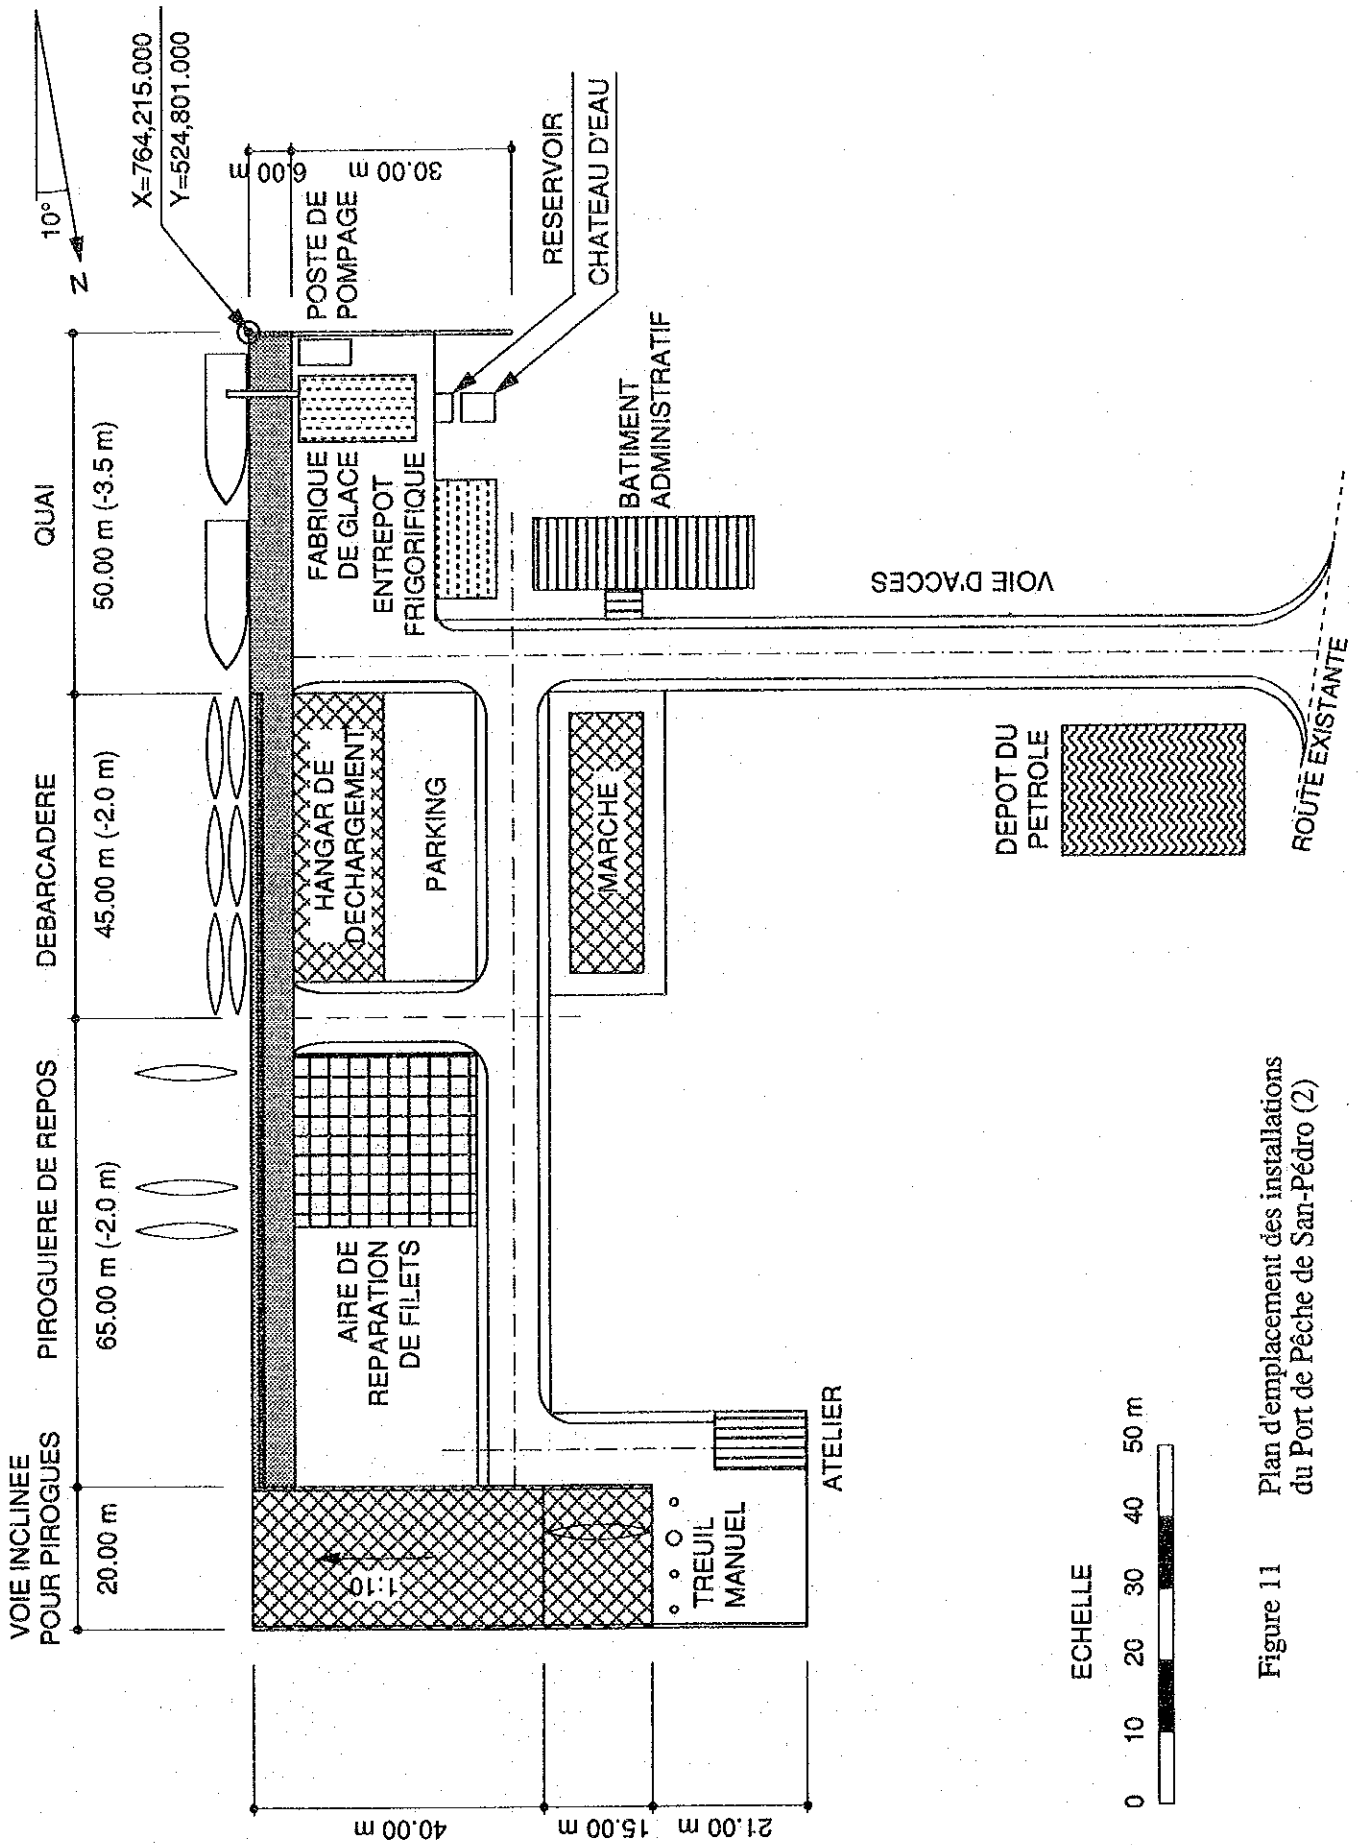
Plan d'emplacement des installations du Port de Pêche de San-Pédro (2)
